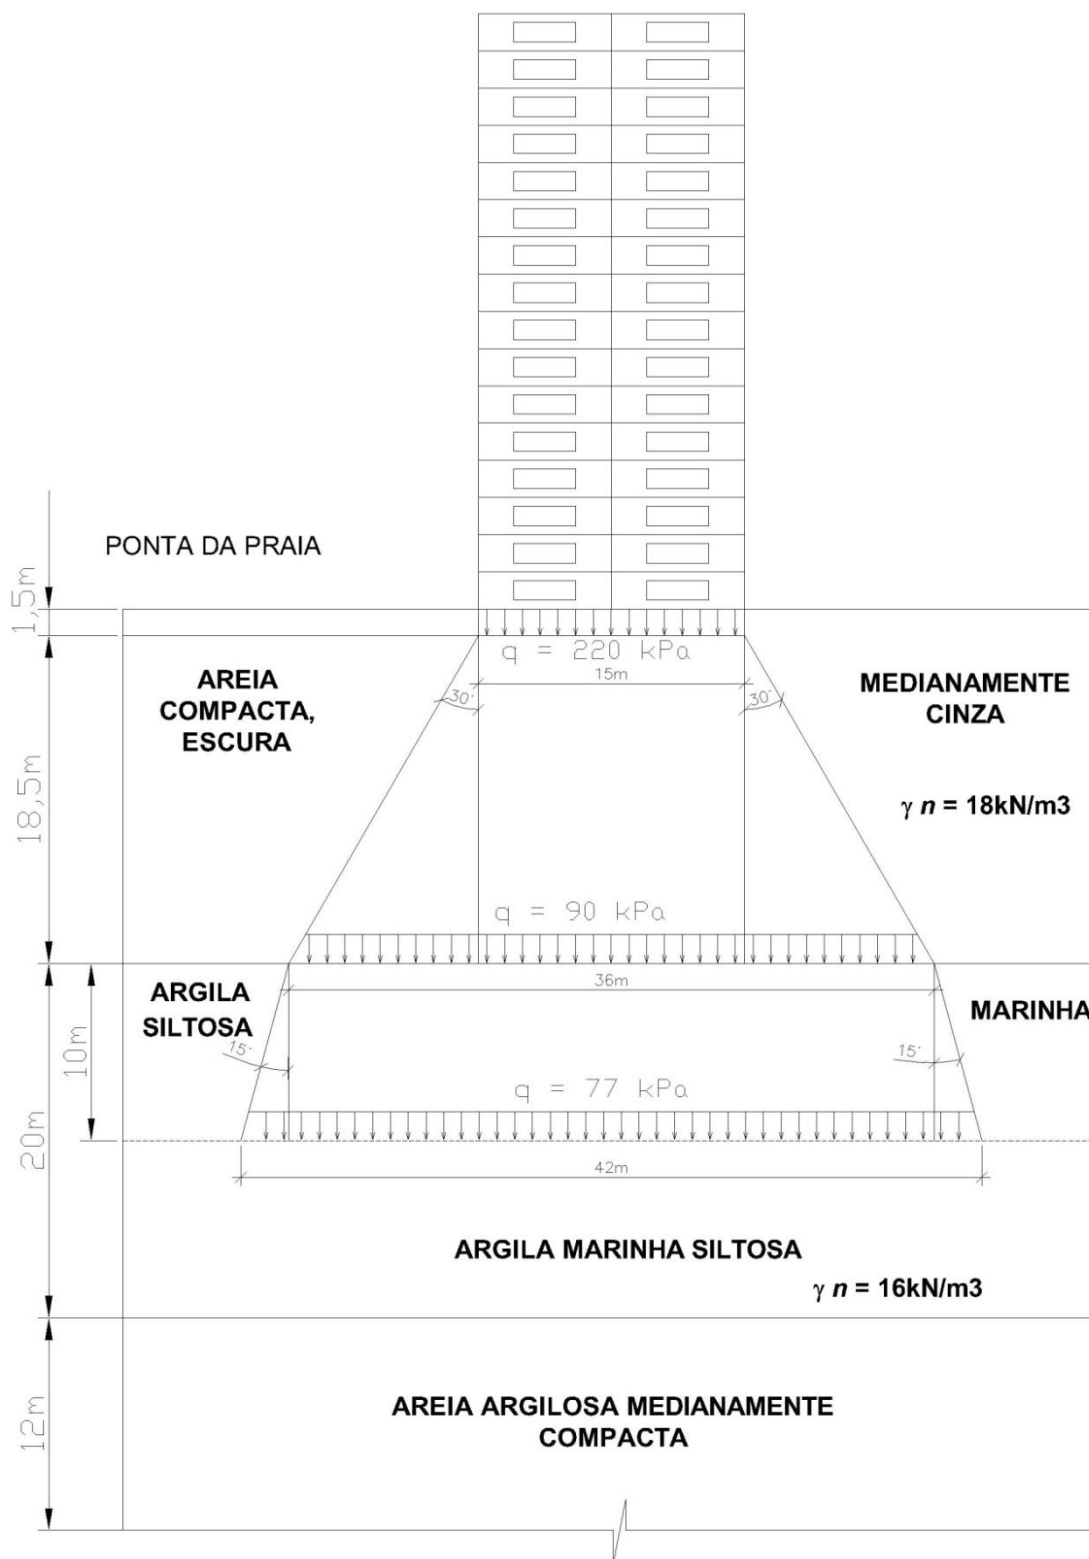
Esquema de dissipação de cargas para o perfil adotado da Ponta da Praia edifício "A", com 16 pavimentos
